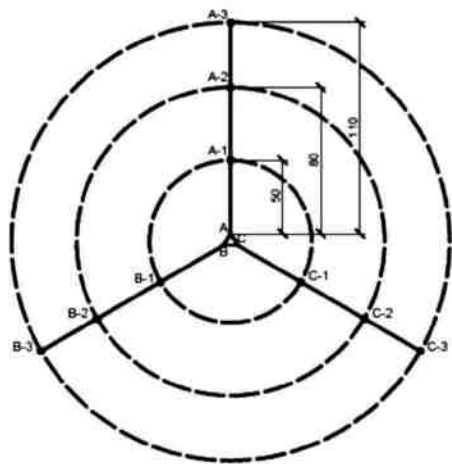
Configuración en planta de la torre, unidades expresadas en metros
